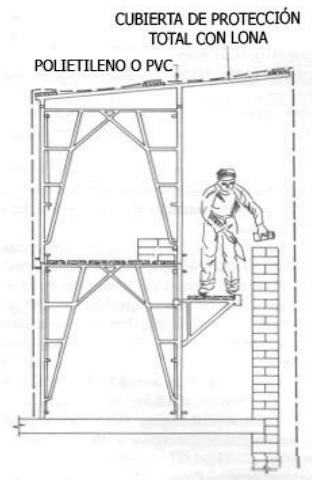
TORRES DE ANDAMIAJE CON CUBIERTA PROTECTORA UTILIZADAS PARA LA COLOCACIÓN DE MAMPOSTERÍA
